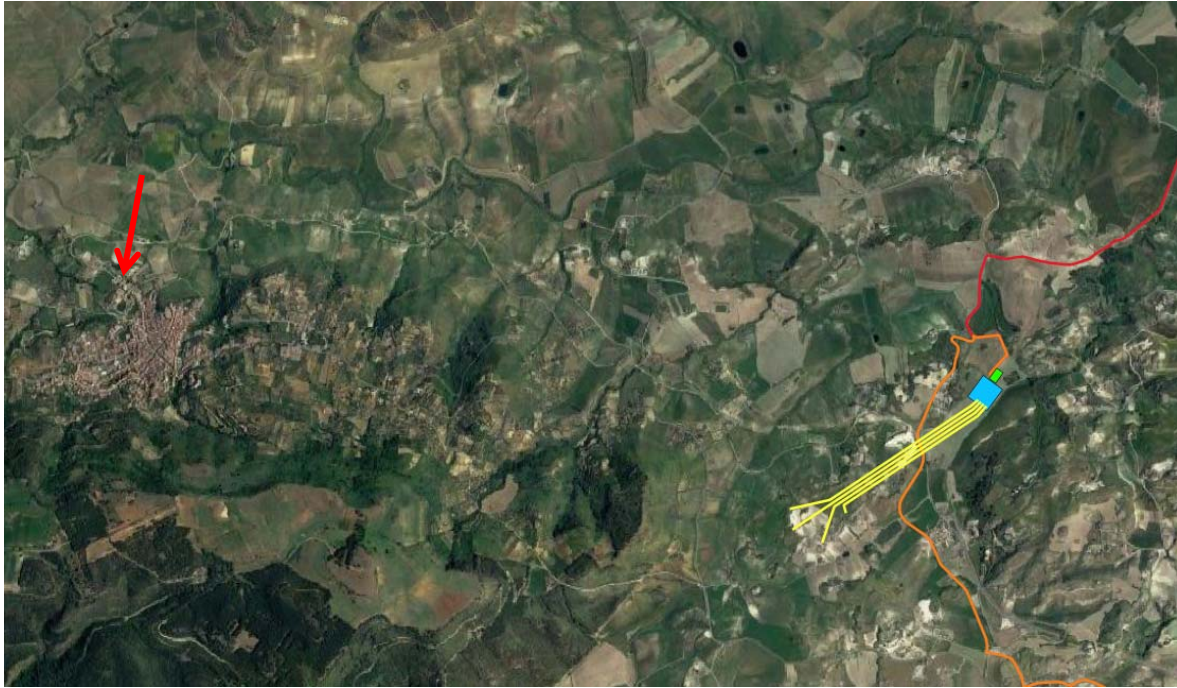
Planimetria con individuazione opere di connessione alla RTN (la freccia in rosso indica l'abitato di San Michele di Ganzaria)
